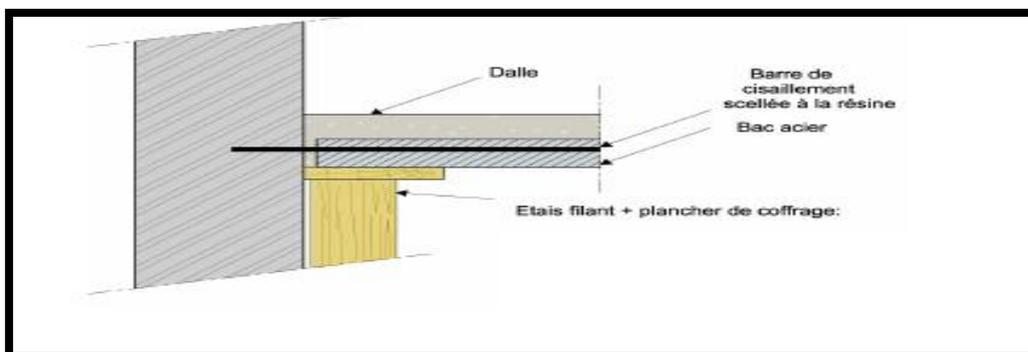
exemple de l'accrochage d'une dalle mixte dans un mur existant
